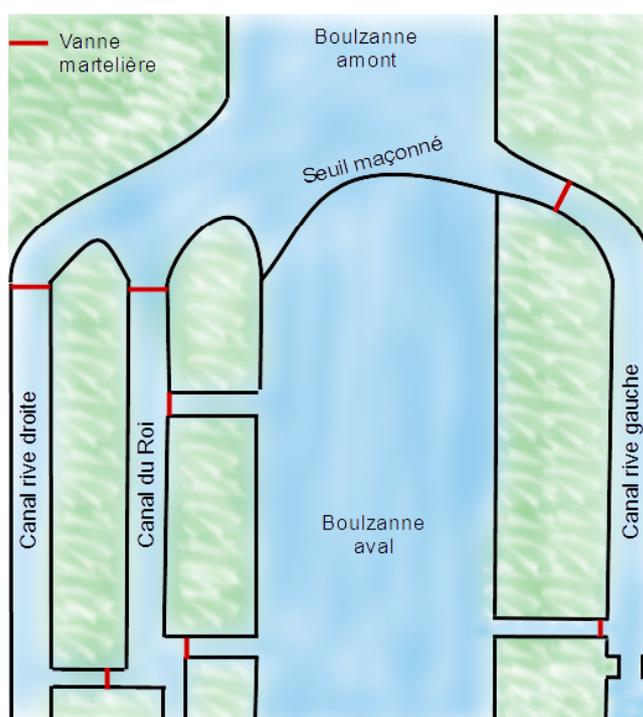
Plan de la prise d'eau Canal de Caudiès
